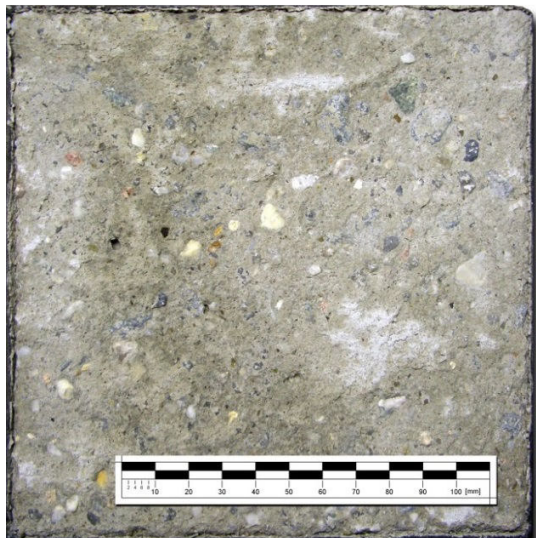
CEM II/B-S (16,8) 20/65 oNB. Betonoberfläche nach 28 FTSW, Abwitterungsmenge 2130 g/m².
